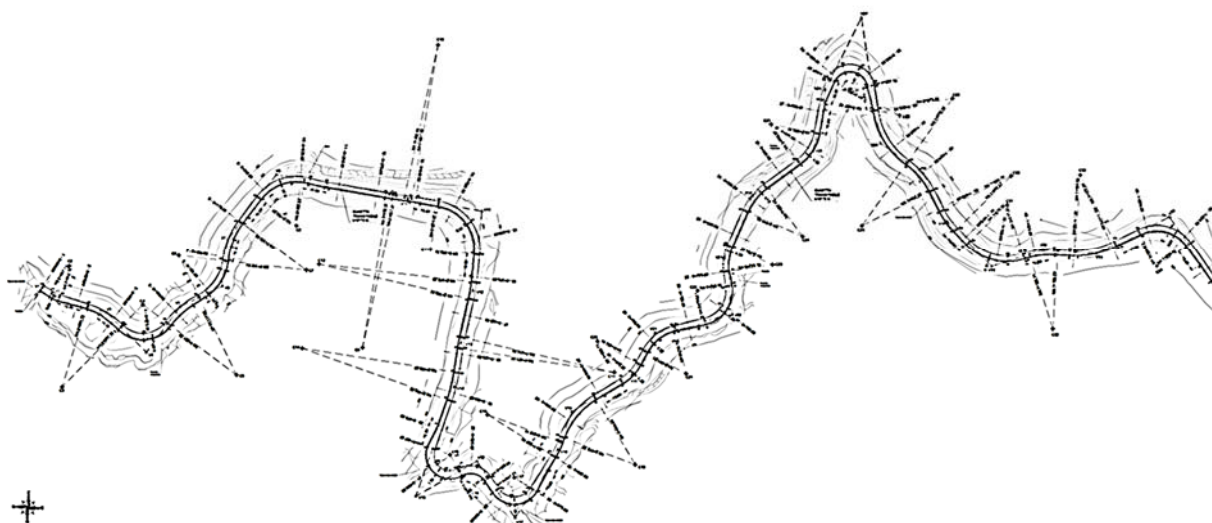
Sviluppo planimetrico della strada ID24 – Parte 1
